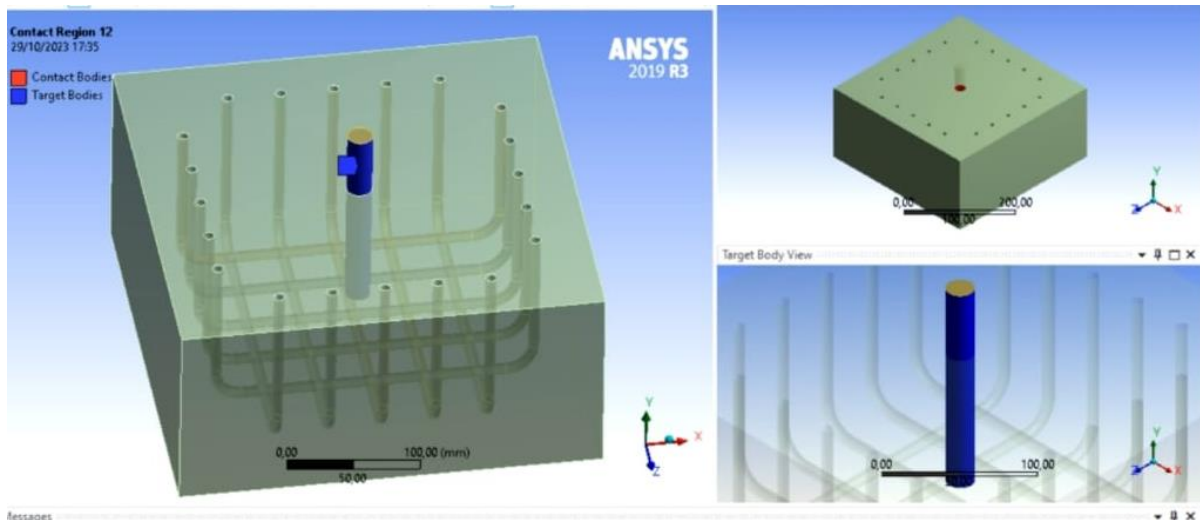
Conexión tipo soldada entre perno de anclaje y concreto
